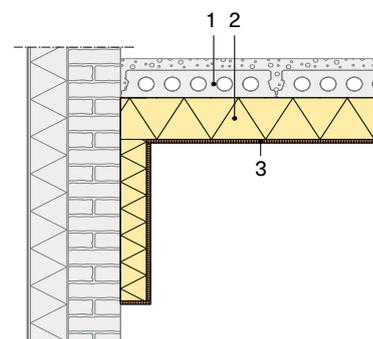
Isolation de la face inférieure d'un plancher en béton à l'aide d'un isolant rigide (vue 2D).
